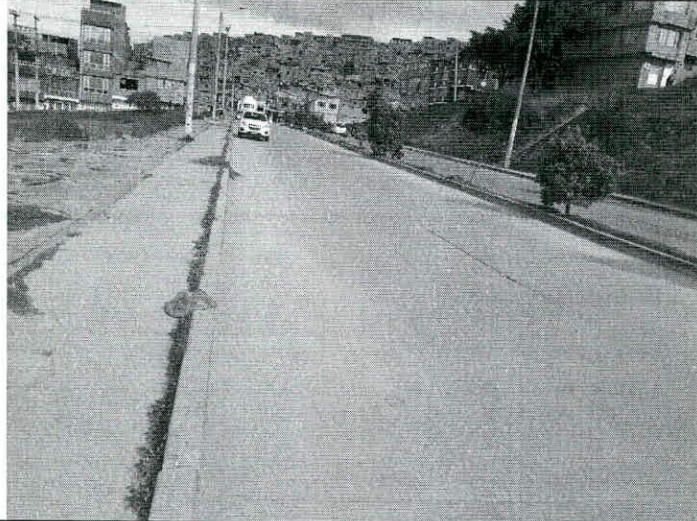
Vista general del sector donde se localiza el predio con dirección Transversal 54 No. 71 – 09 Sur.
